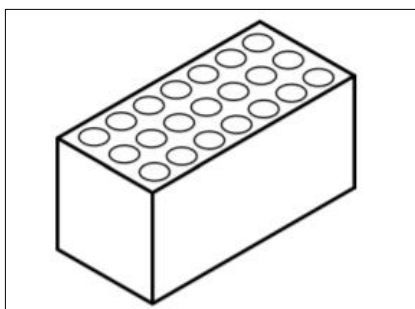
Bloco cerâmico estrutural com paredes maciças e paredes internas vazadas
